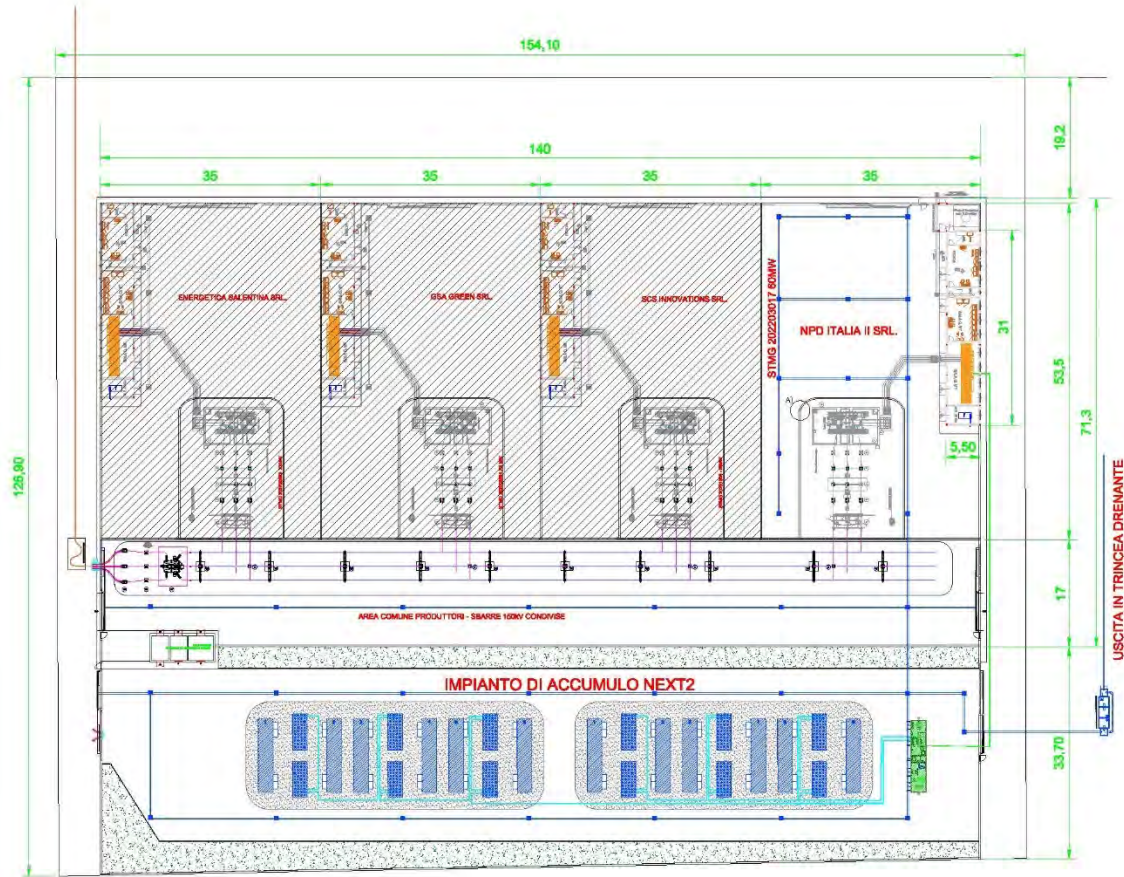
Planimetria Layout SSE PRODUTTORI e impianto di accumulo NEXT2
